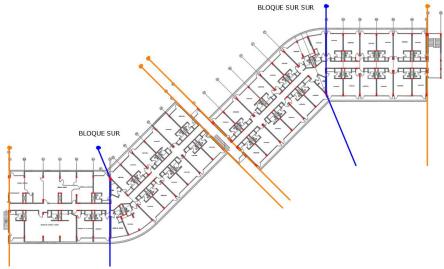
Planta Bloque Sur Sur y Bloque Sur
